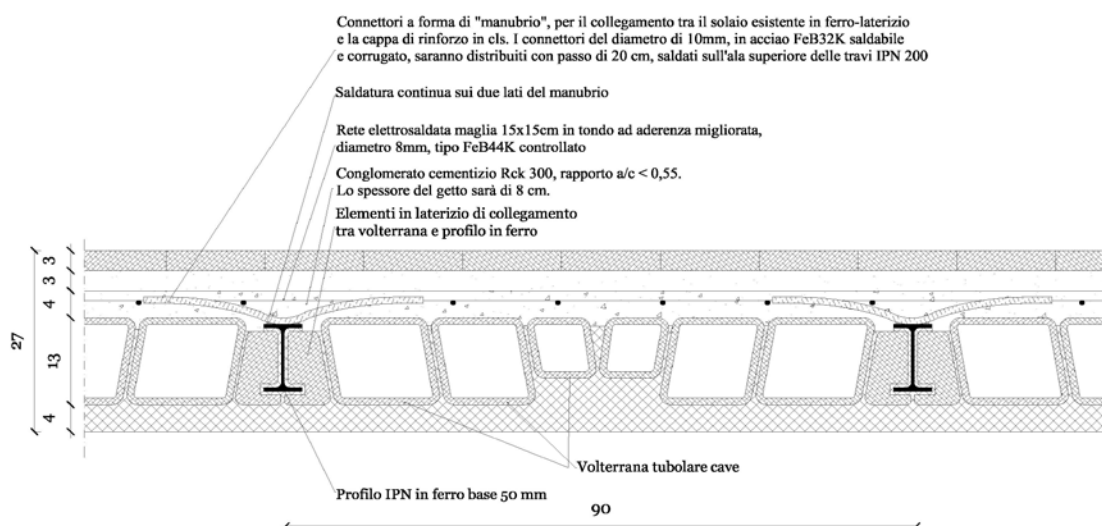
Schema solaio stanza 4.1 – Progetto ing. Jurina
